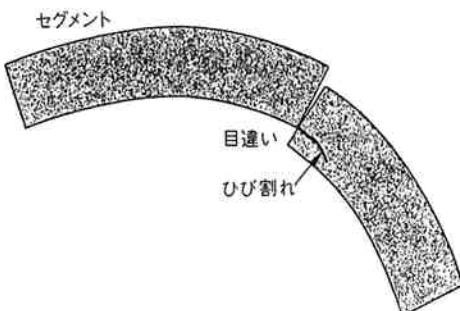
目違いによるひび割れ(横断面)¹⁾
